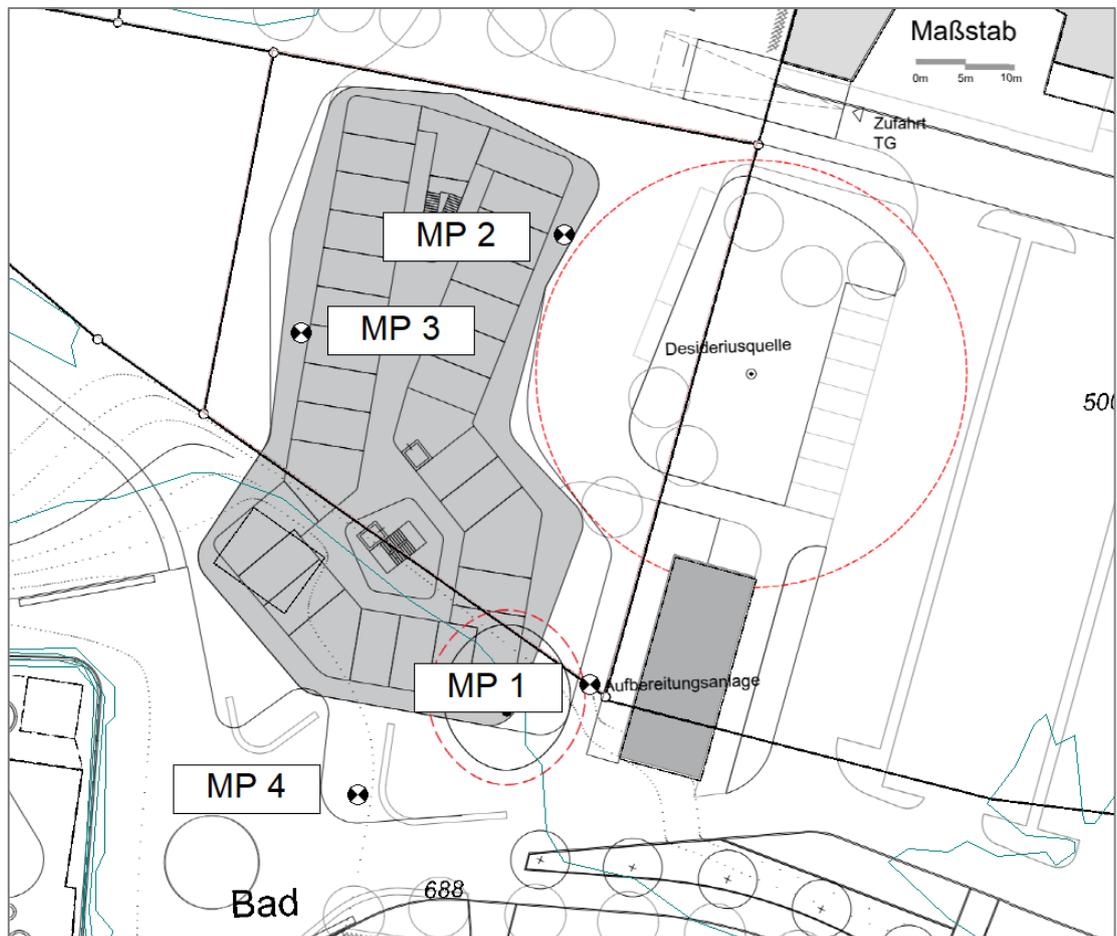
Quartier an der Therme in Bad Aibling, Lageplan zum Stand der städtebaulichen Voruntersuchung, Planstand Februar 2025 [8].
